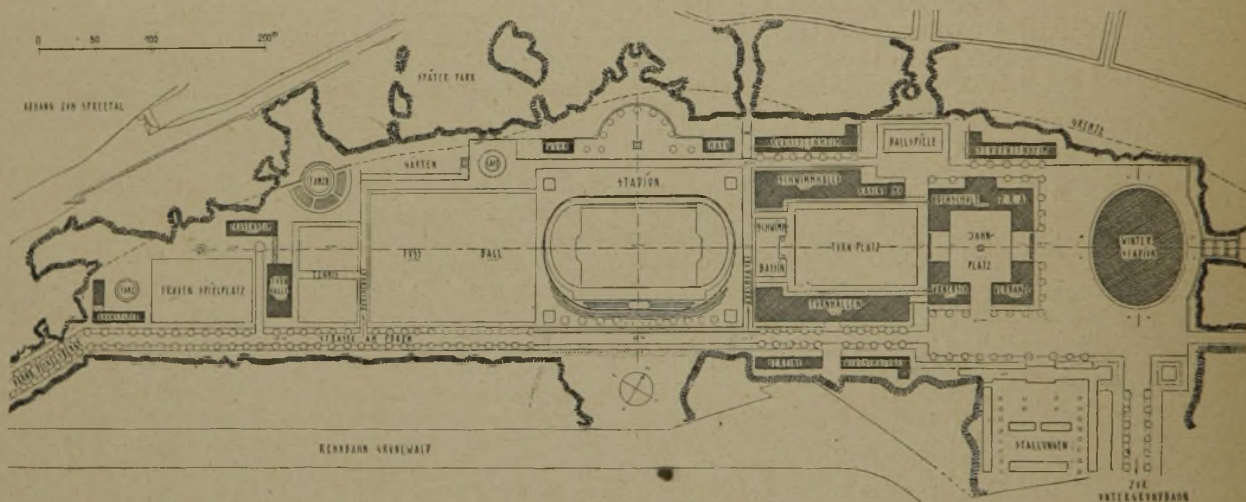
Lageplan in Beziehung zu Stadion und Rennbahn.
